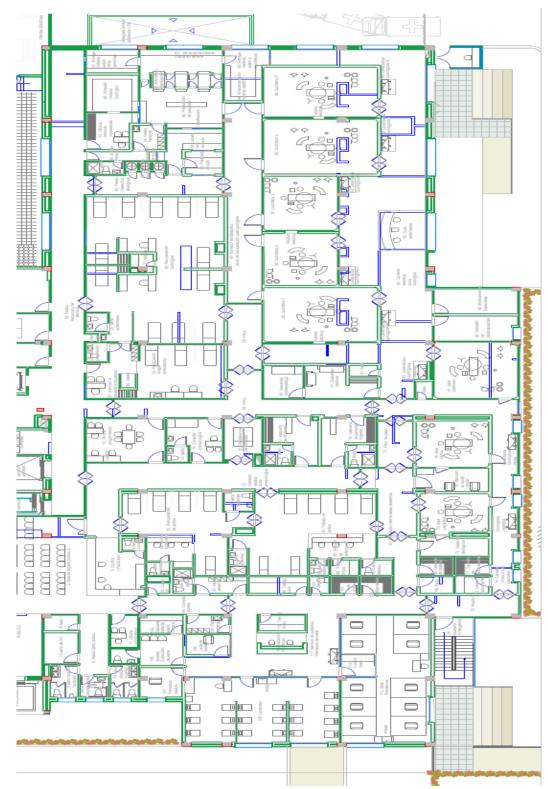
Planta existente piso 2. Fuente. Gobernación de Arauca
